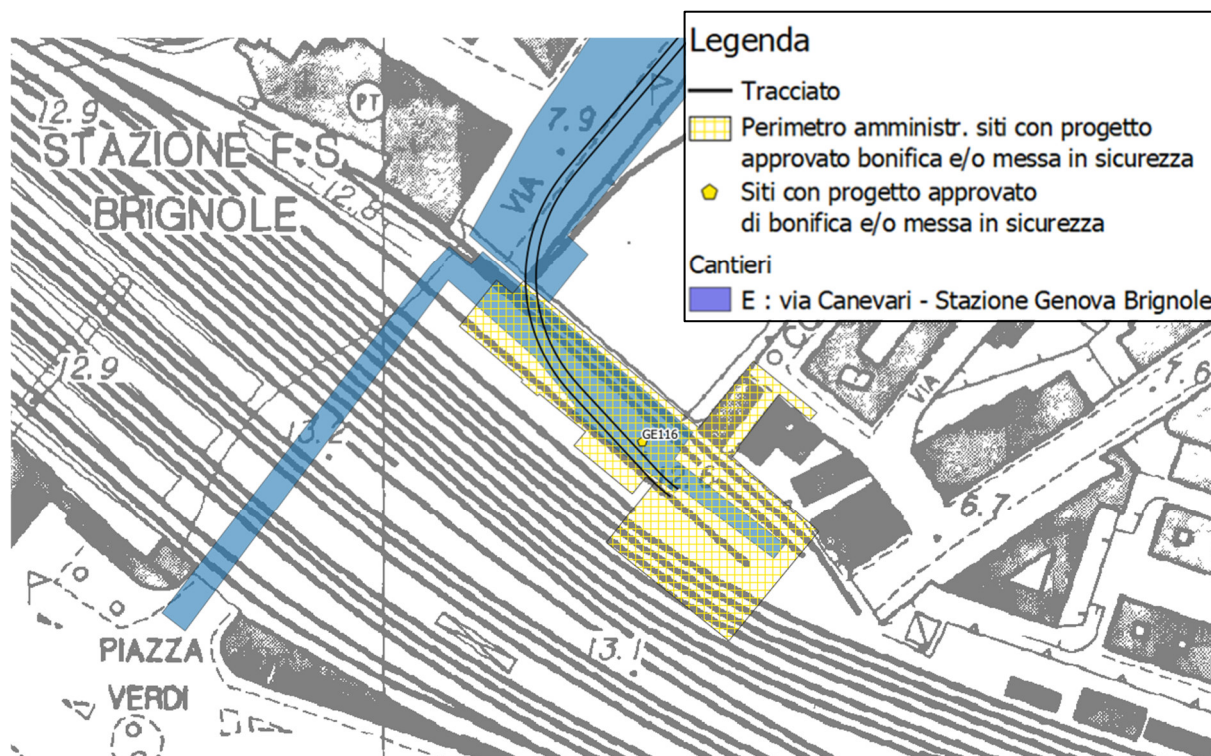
Interferenza tra sito GE116, tracciato di progetto e cantiere E
